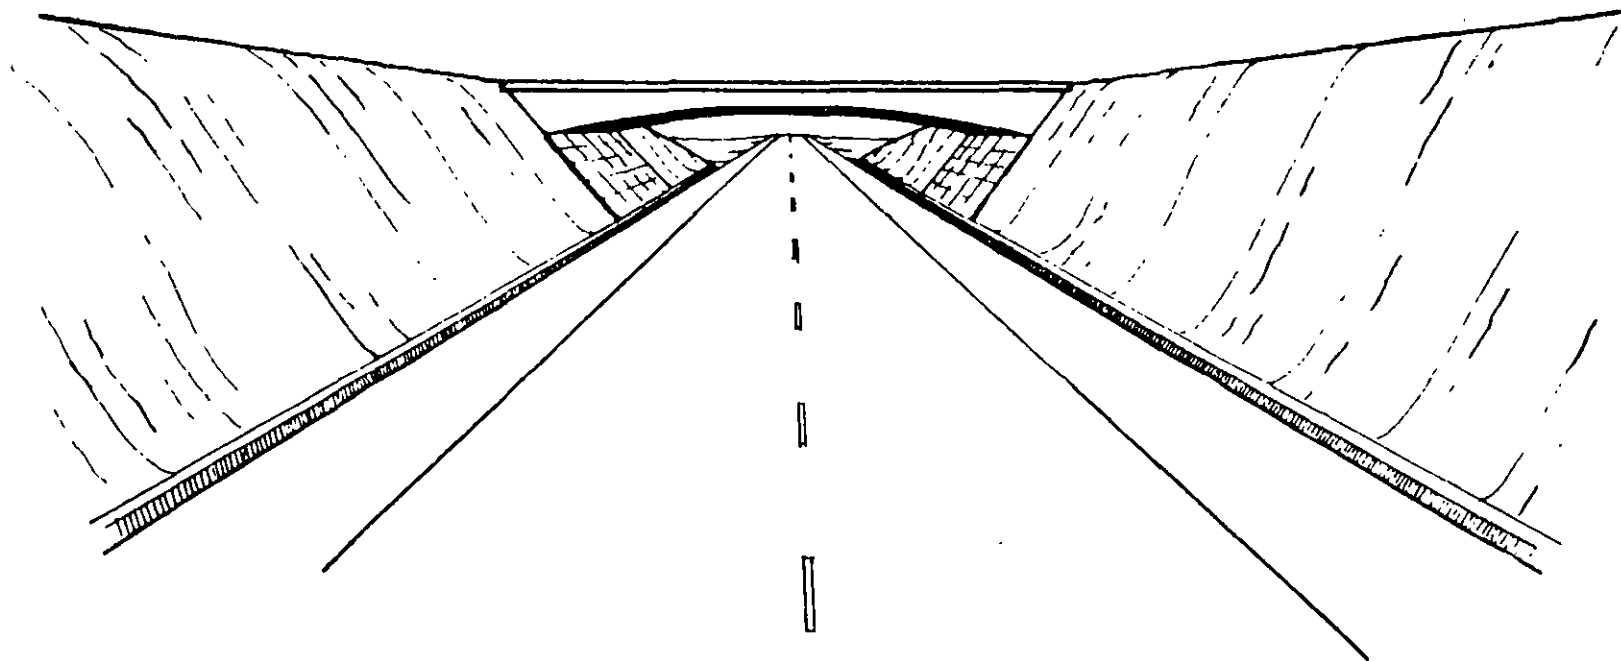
PASO A DESNIVEL LOCALIZADO SOBRE TERRENO NATURAL EN CORTE
